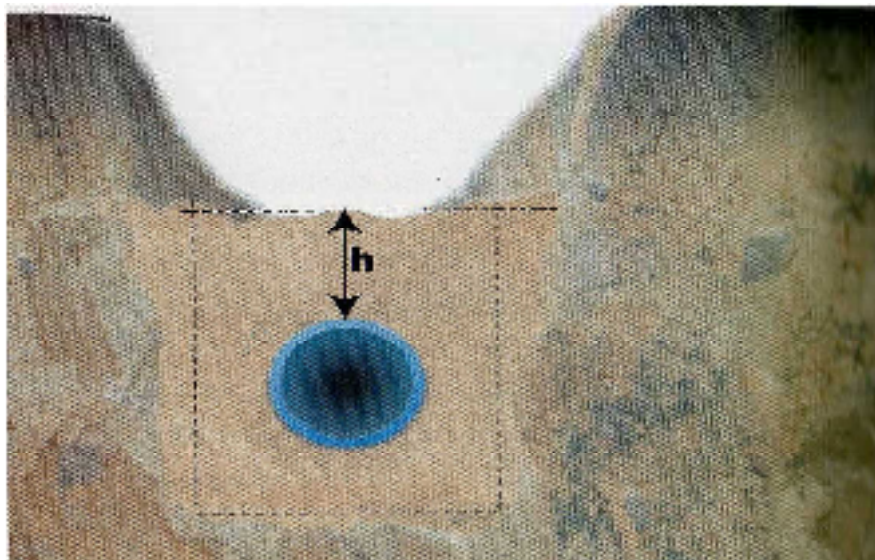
schéma présente la hauteur du remblai de protection au-dessus de la conduite.
